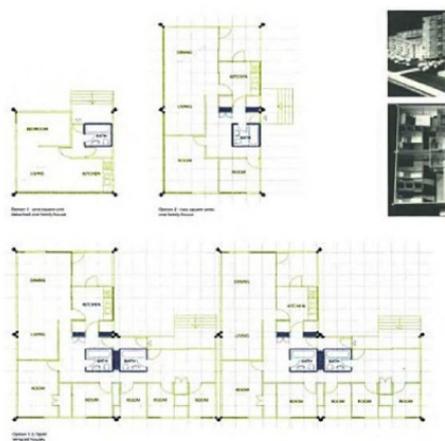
Plantas Sistema L, Van den Broek y Bakema, 1970
